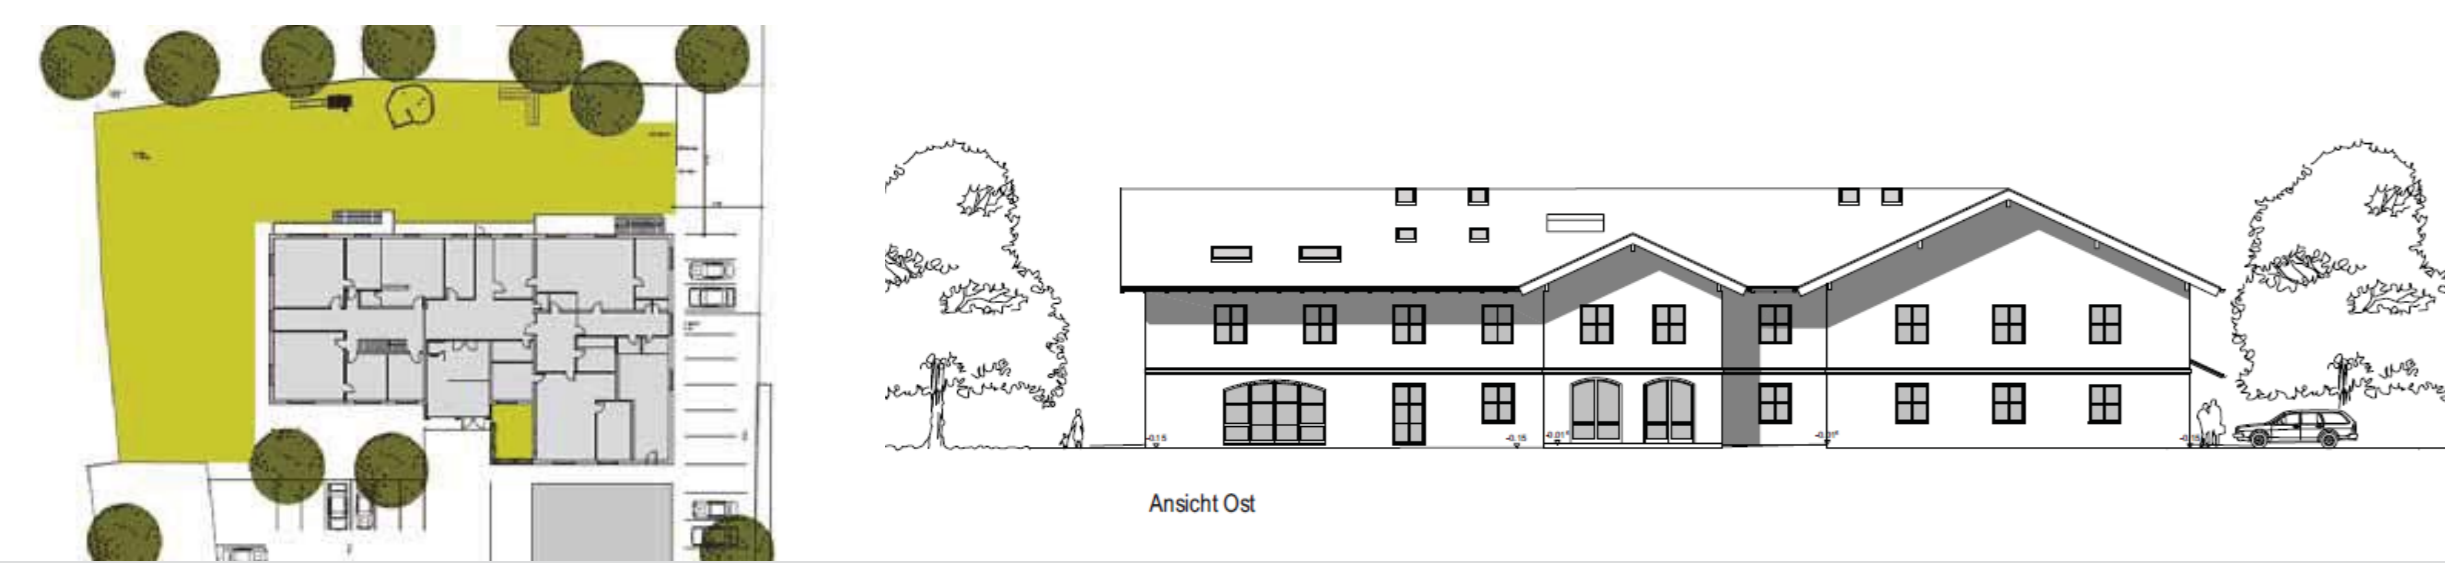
und 2: Lageplan und Ansicht des Kinderhauses „Schatzkiste“
